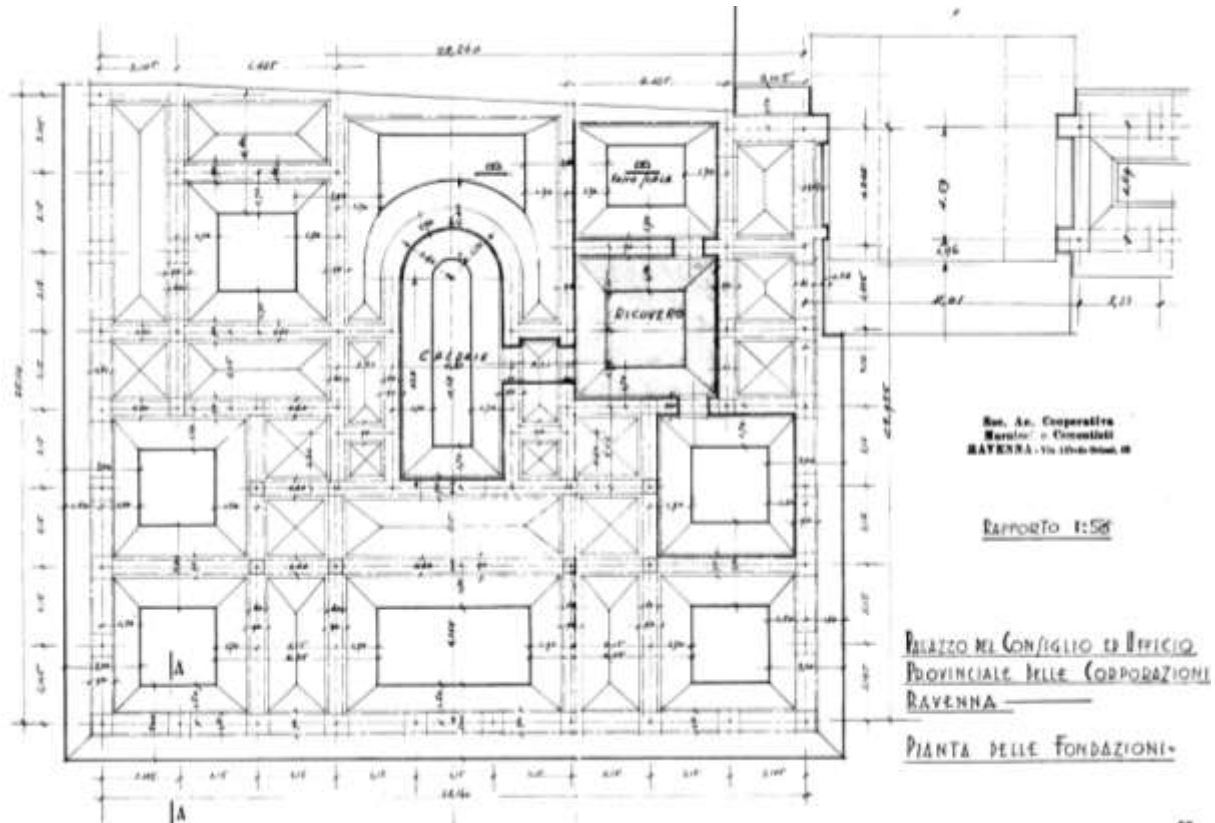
Pianta delle fondazioni e indicazione della zona destinata ad ospitare il rifugio antiaereo (progetto preliminare).
